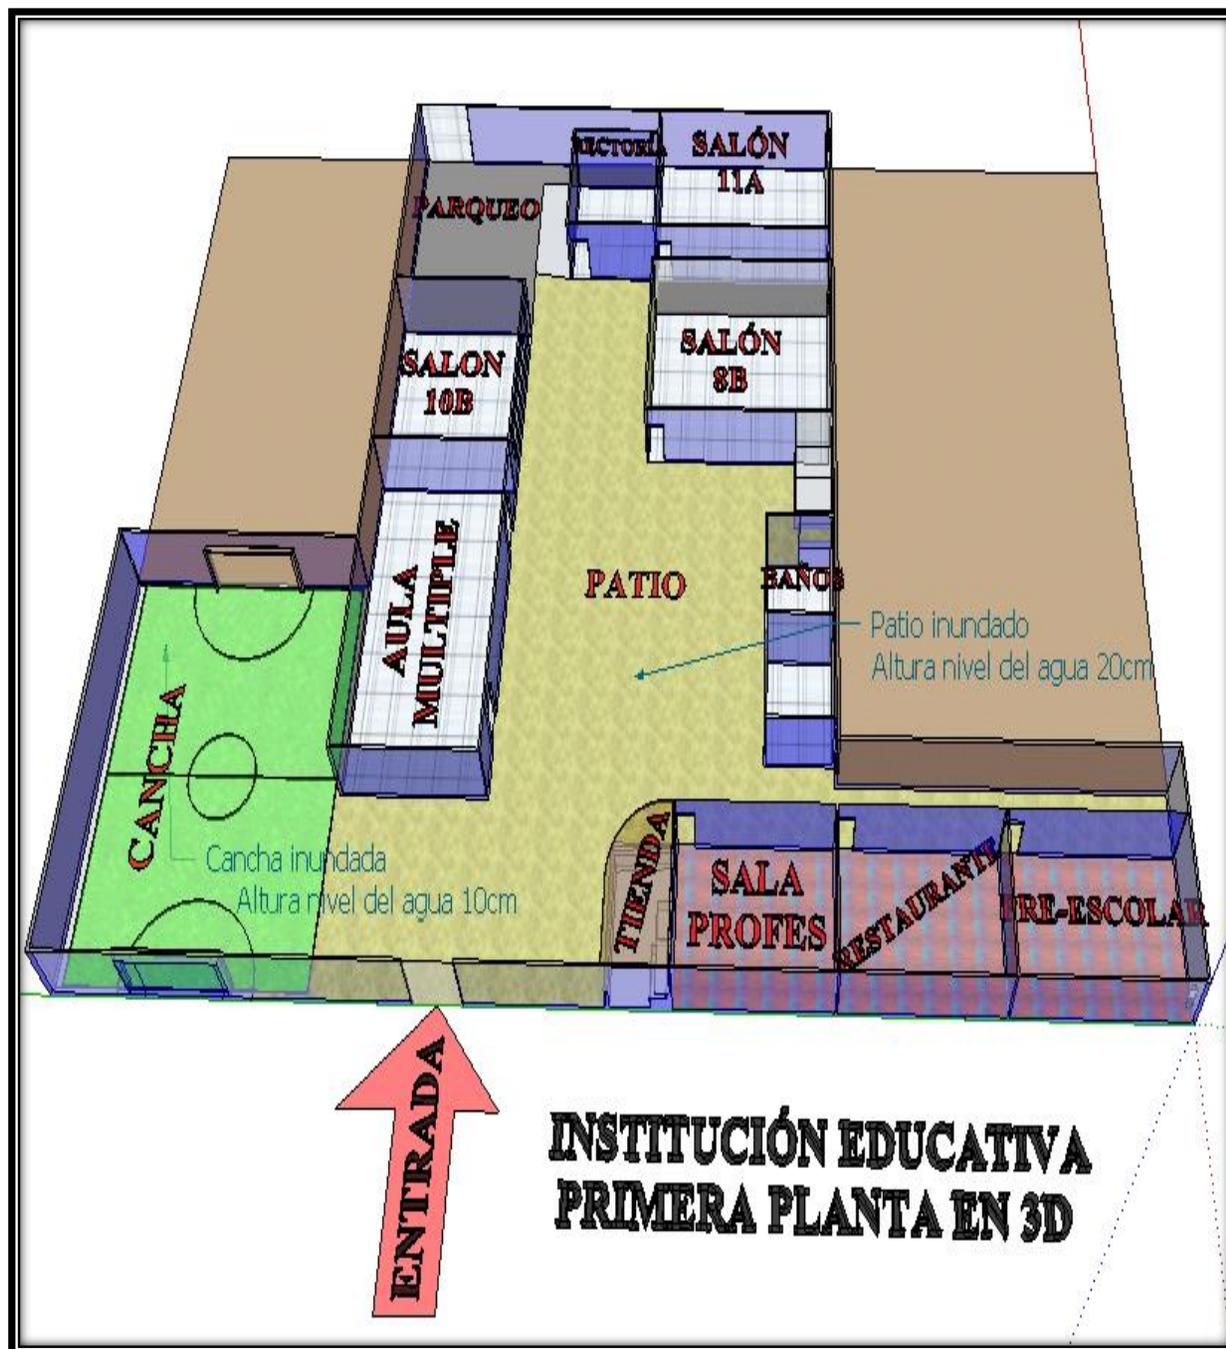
Plano en planta de la Institución vista en 3D. Google Sketchup.
